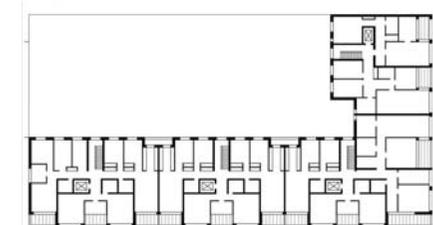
Grundriss EG und A 2.7 2. OG
